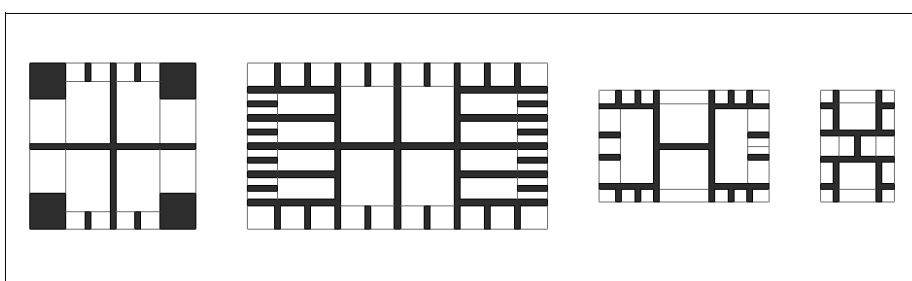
Planta típica de torre de cuatro lados. Elaboración propia (Roaf, 1988)
